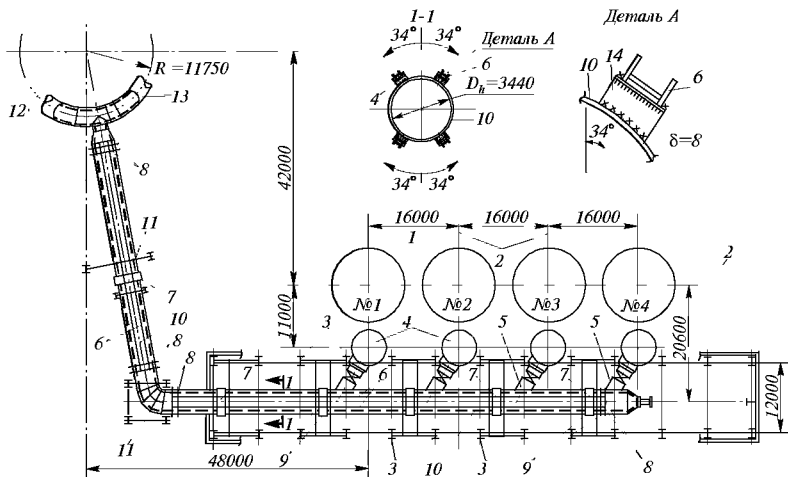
План блока воздухонагревателей и воздухопровод горячего дутья
